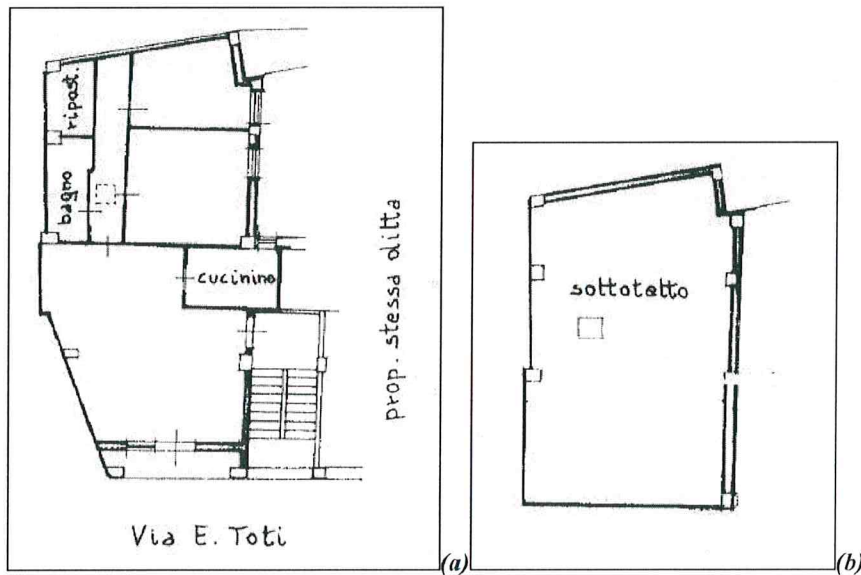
Planimetrie catastali dell'appartamento ubicato in via Enrico Toti n° 2A – Scala B interno 3: piano secondo (a); piano terzo sottotetto (b).
